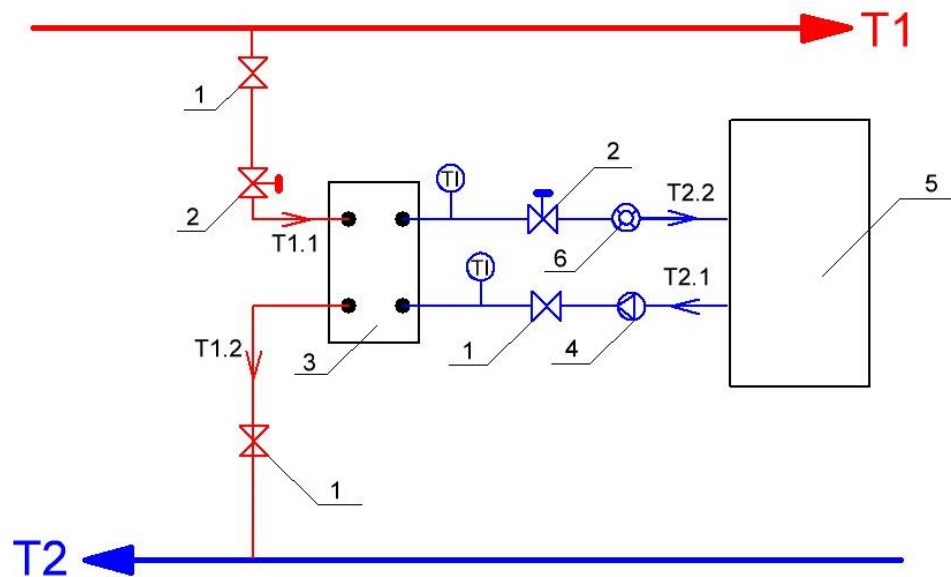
Принципиальная схема промышленной установки для теплотехнических испытаний теплообменного оборудования в системе отопления:
